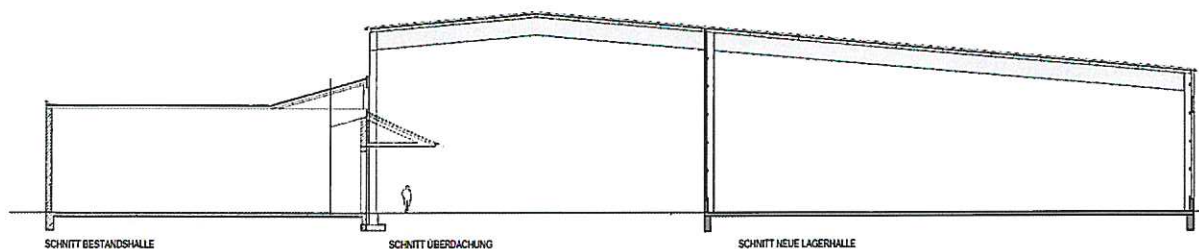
Schnitt der geplanten Anbindung Bestandshalle – überdachte Ladezone – neue Lagerhalle
